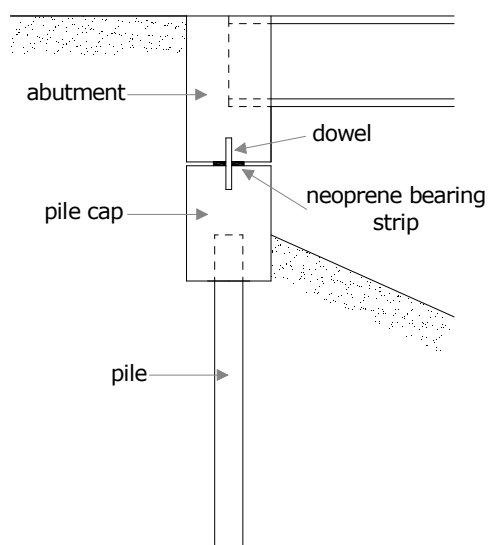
Connessione sovrastruttura – spalla, *schema 5
